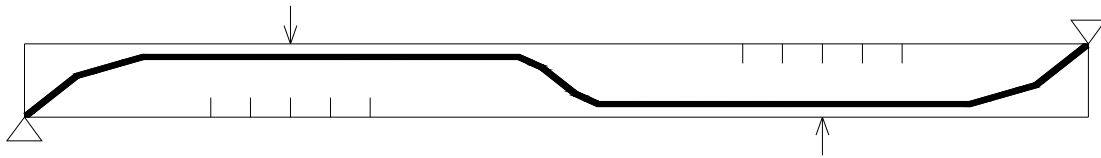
Tipos de fissuras em vigas de concreto (adaptada do ACI 318-08:2008).
